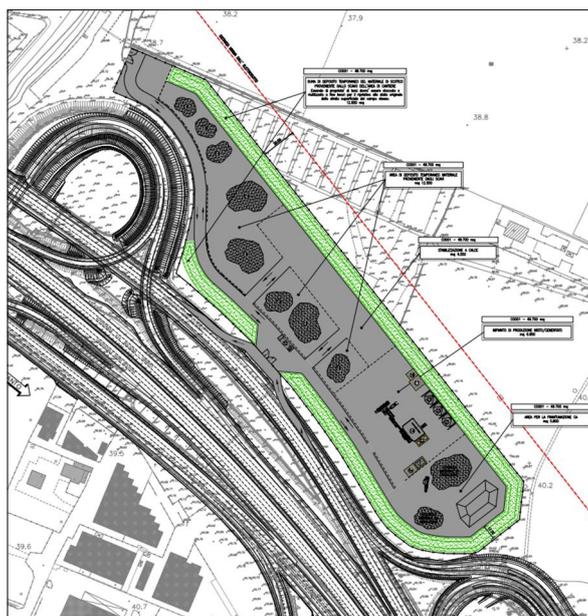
Layout dell'area di cantiere CO01 (stralcio da SIC5300)
